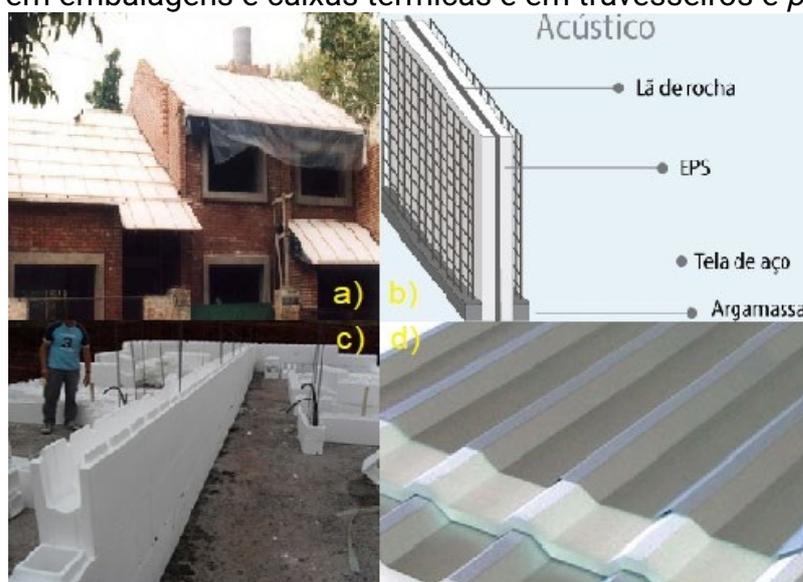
Aplicações de EPS em construção civil: (a) isolamento térmico, (b) isolamento acústico, (c) blocos e (d) telha termoacústica (THAIS, 2014).
